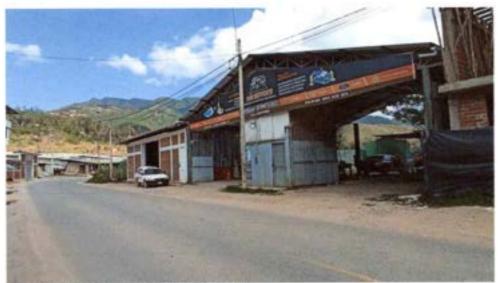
VISTA DE LAVADERO DE VEHICULOS
